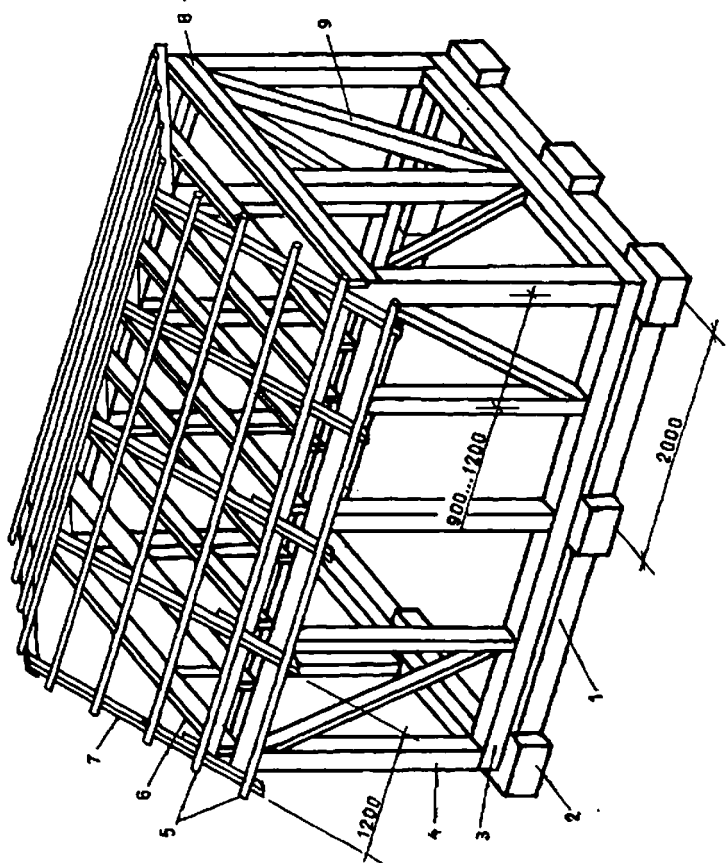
Каркасная конструкция с прямой передачей нагрузок по несущим элементам:
